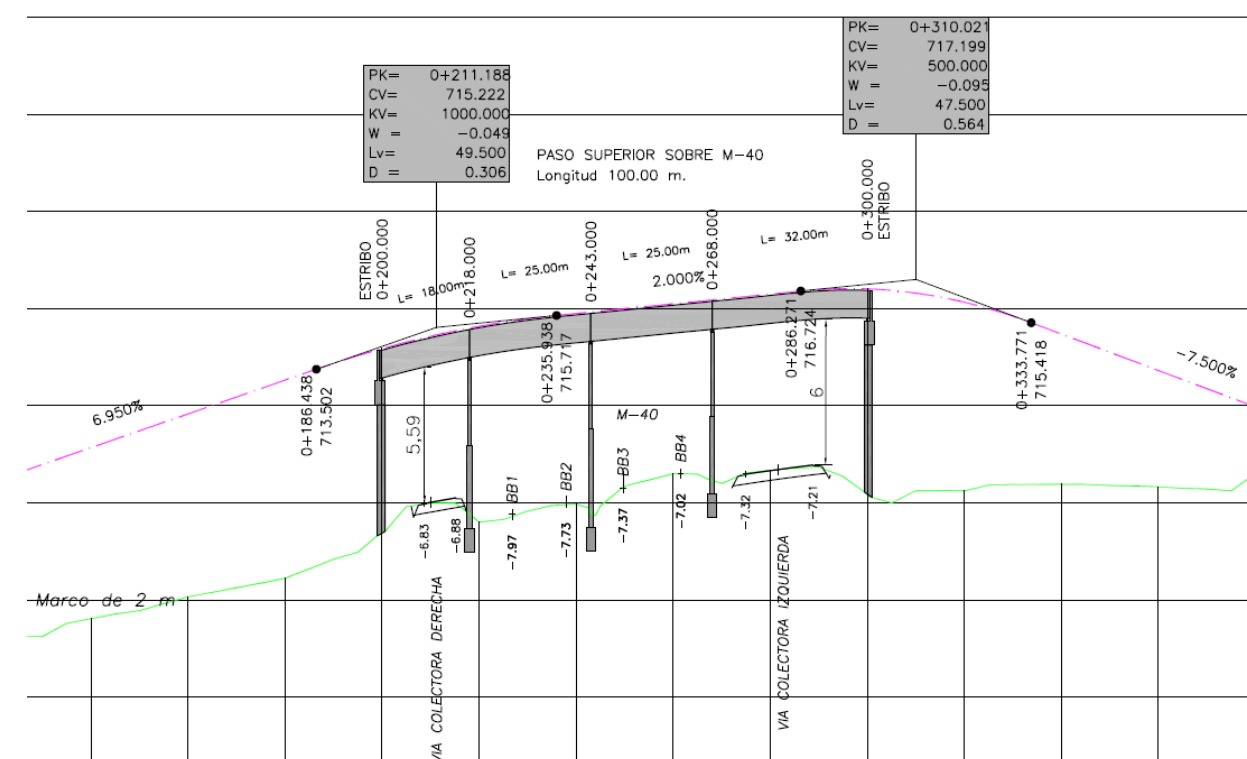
Perfil longitudinal ESTRUCTURA 2
